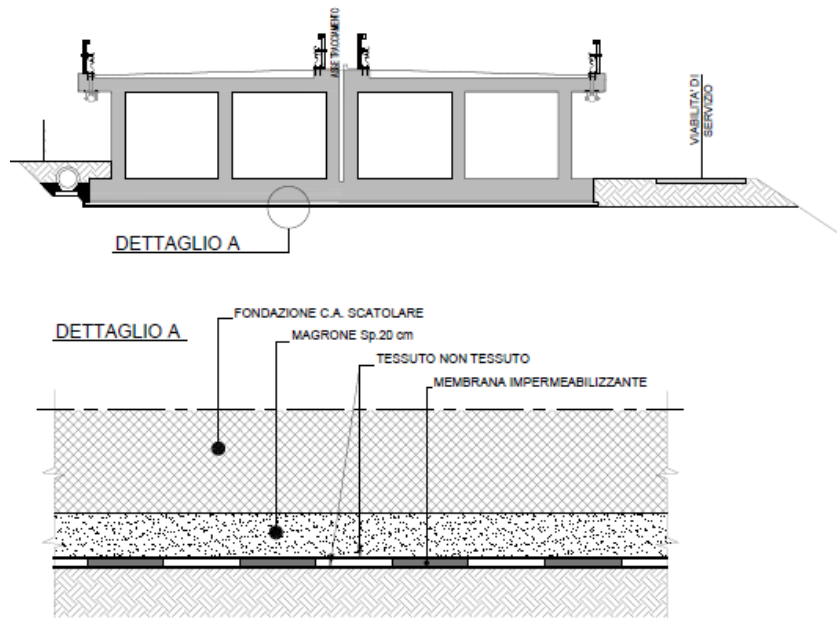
Sezione tipo pavimentazione presso interferenza poligono So830
